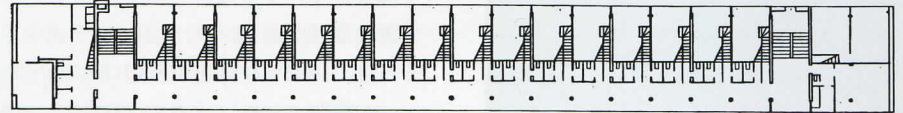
「ナルコムフィンのドーム・コムナ」5階平面図
